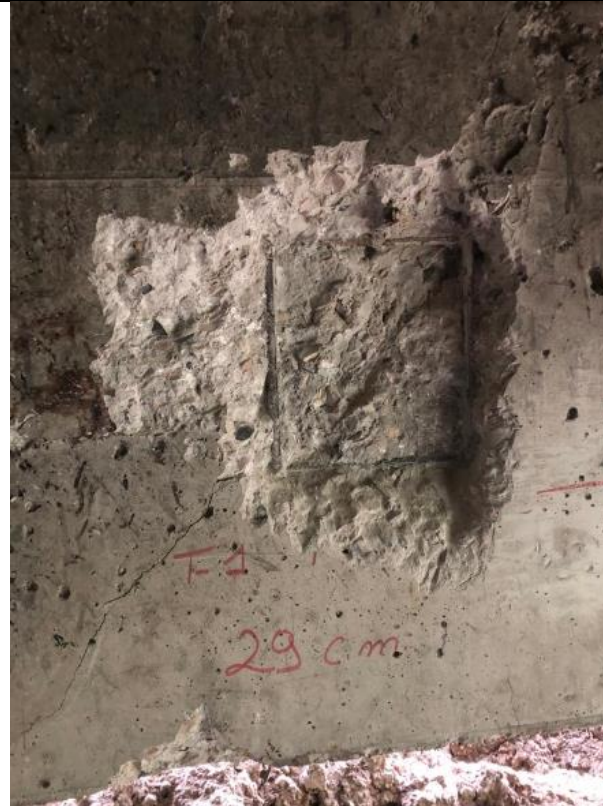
Acero de refuerzo transversal existente en la viga del puente .
